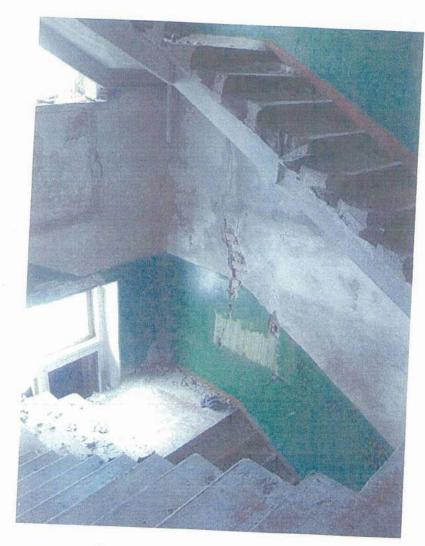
Лестничная клетка ЛК-2. Фрагмент лестницы между 2-ым и 3-им этажами.
